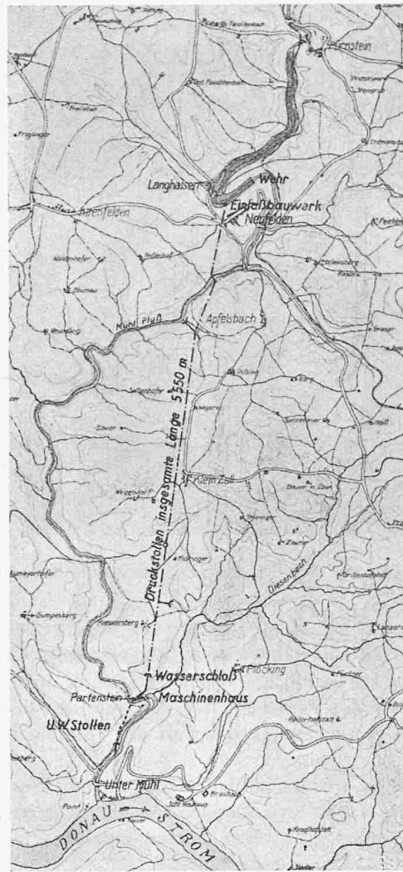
Lageplan. — Masstab 1 : 80 000.
